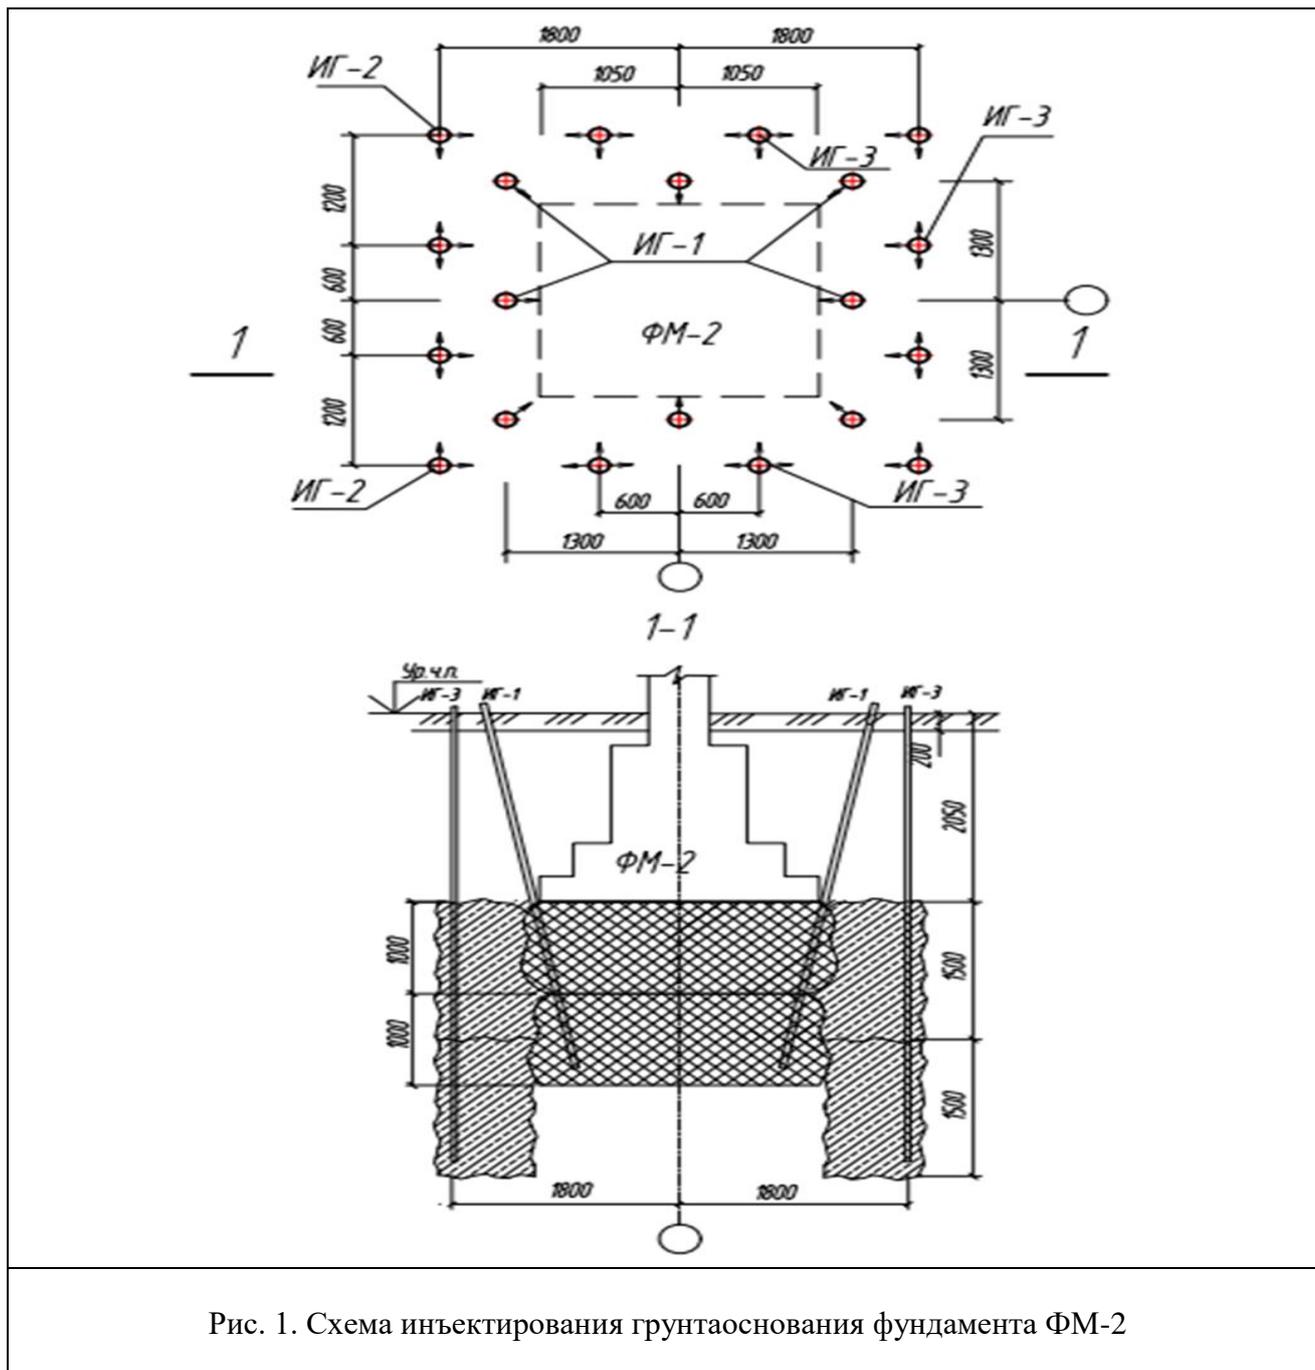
Схема инъектирования грунта основания фундамента ФМ-2
